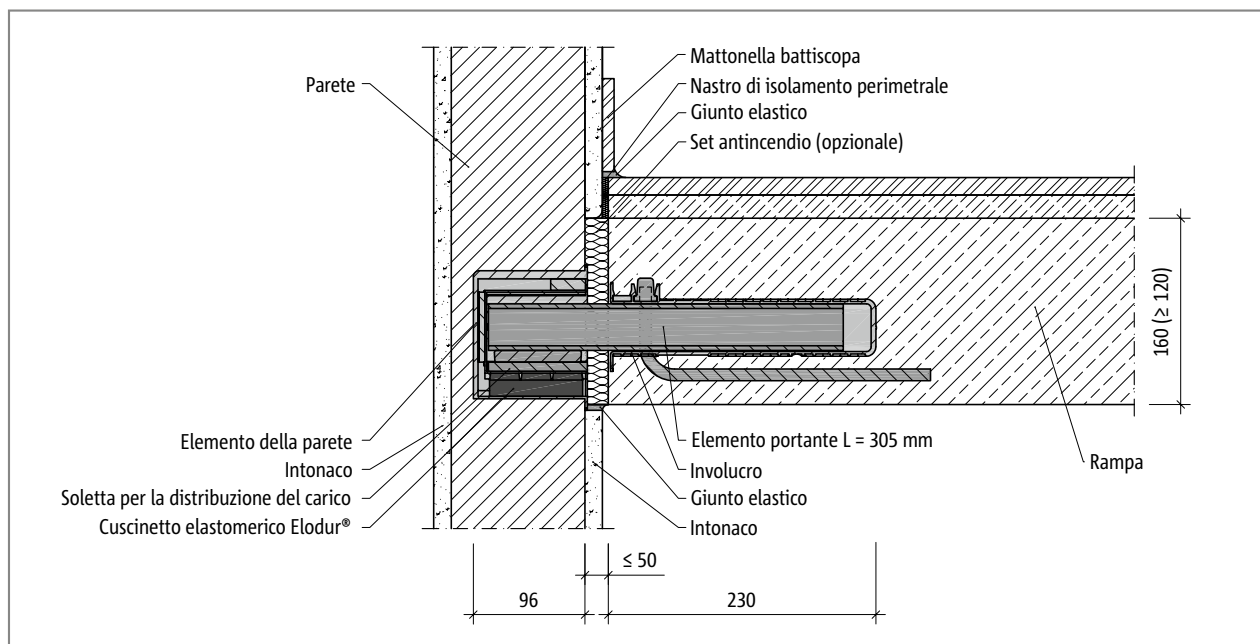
Schöck Tronsole® tipo Q-FV o Q-A2, sezione costruttiva
